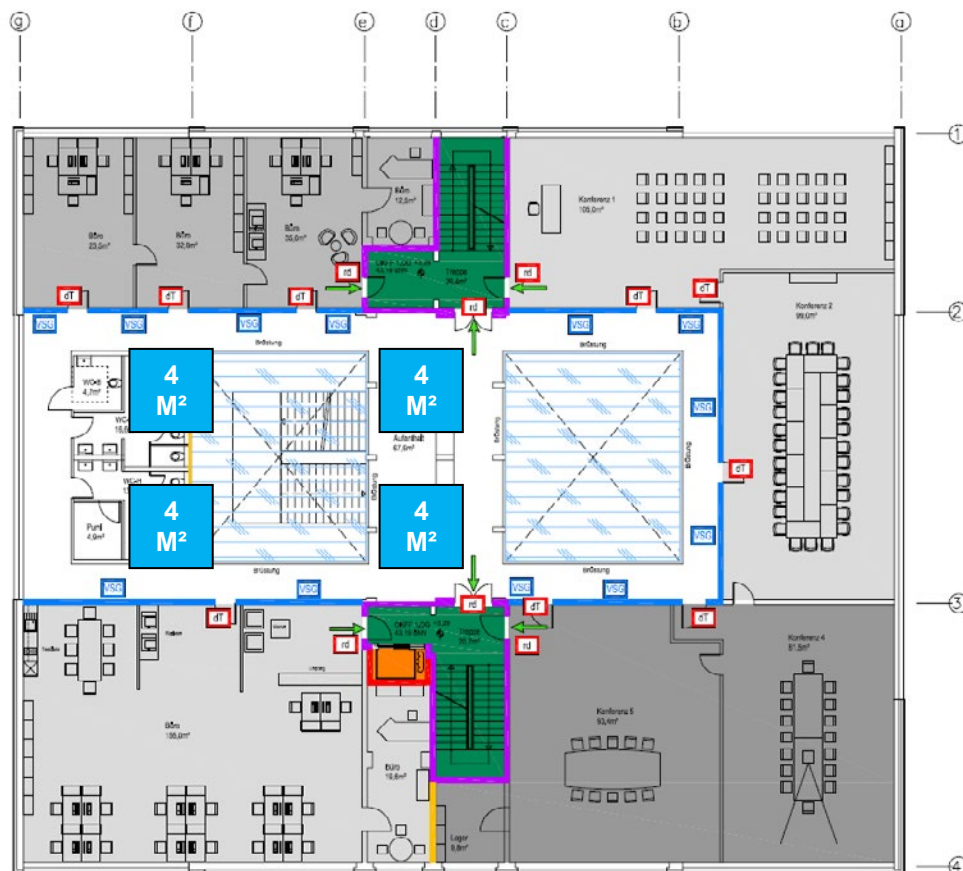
Grundriss 1. OG des Verwaltungsgebäudes mit Position der Abluftöffnungen im Dach
